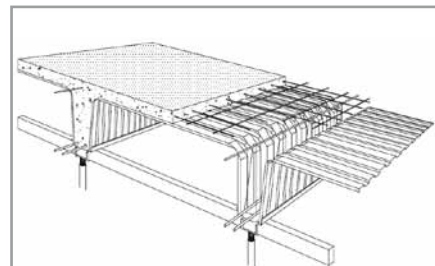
Схема готового перекрытия МАРКО-ПРОСТОП
